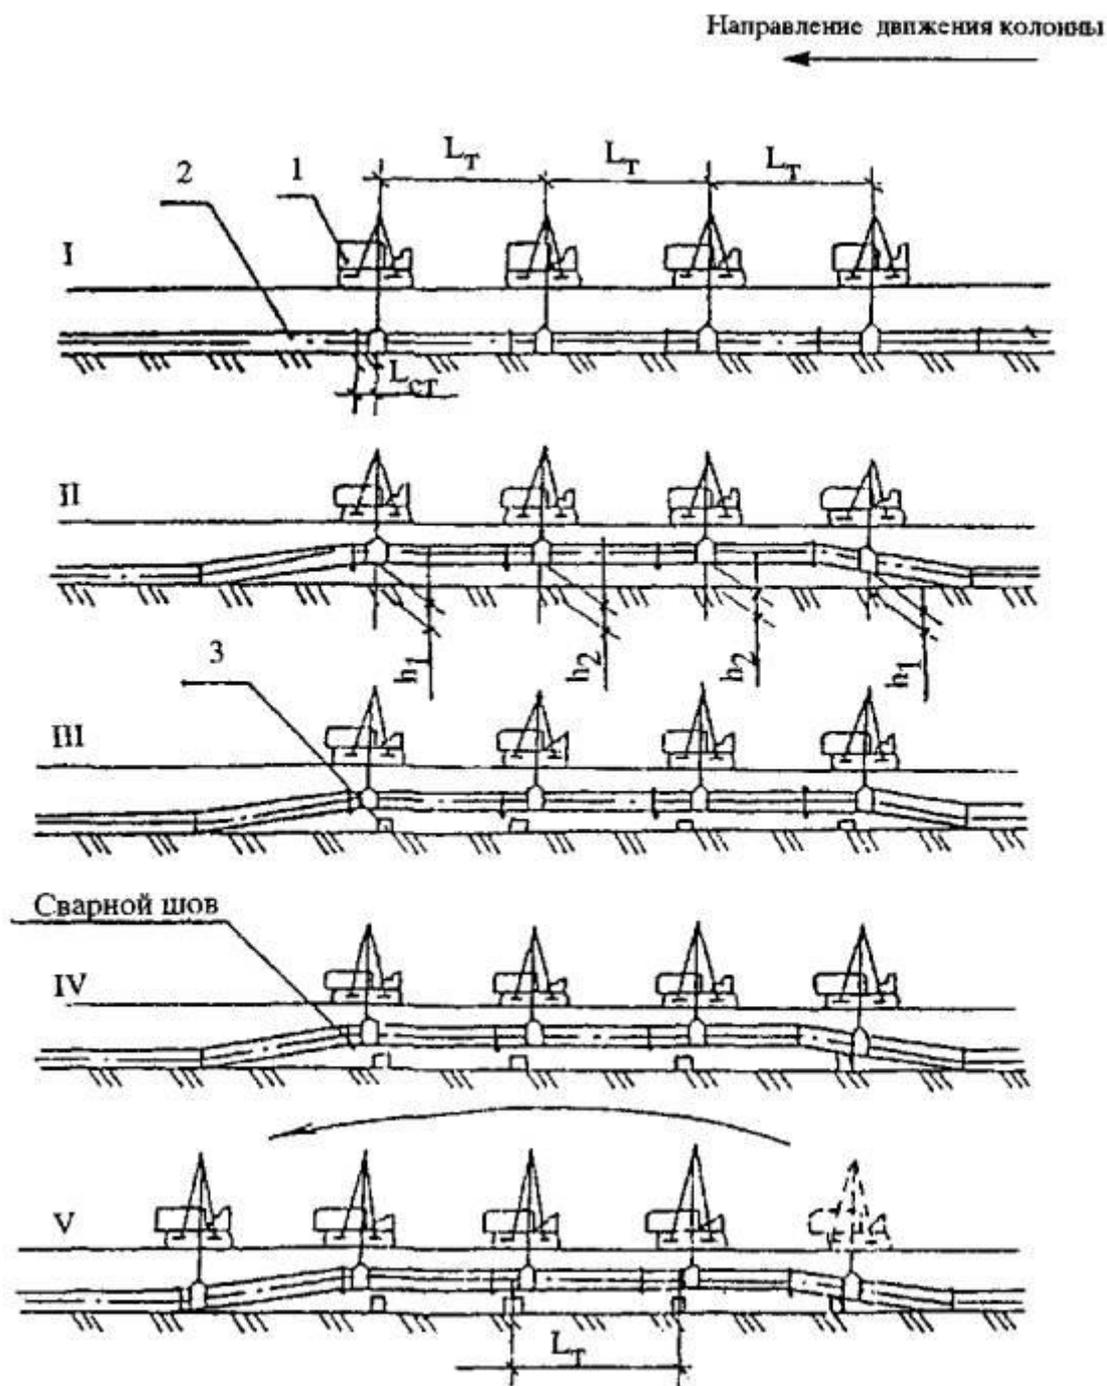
Схема подъема и укладки нефтепровода на лежки с переходом одного трубоукладчика
